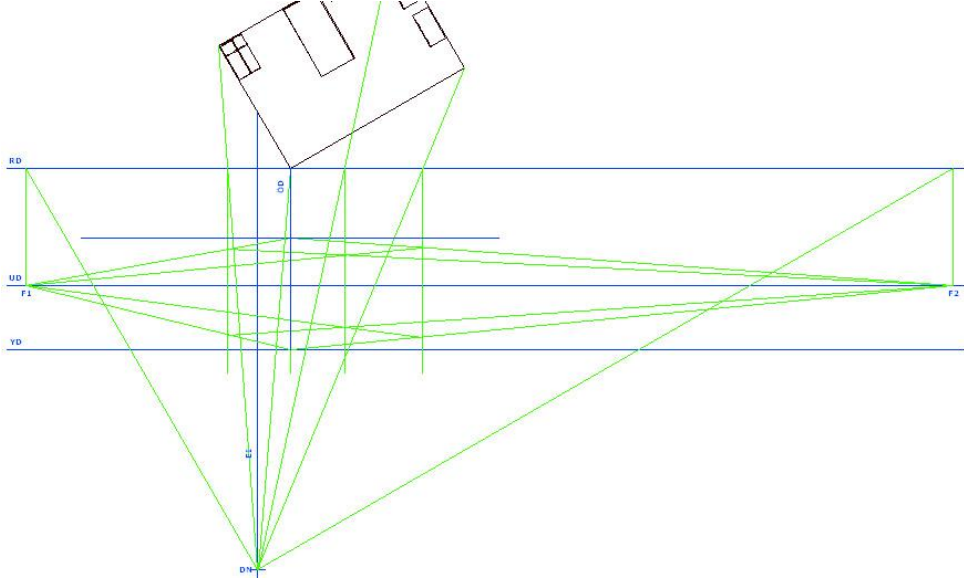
Resim düzlemini kesen ışıkların yer düzlemine taşınması
